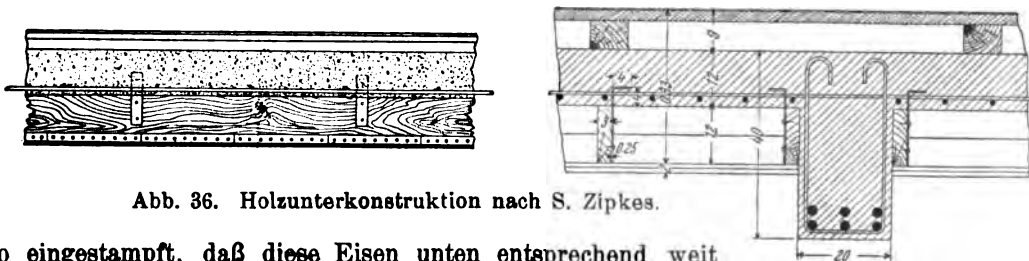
Holzunterkonstruktion nach S. Zipkes.
